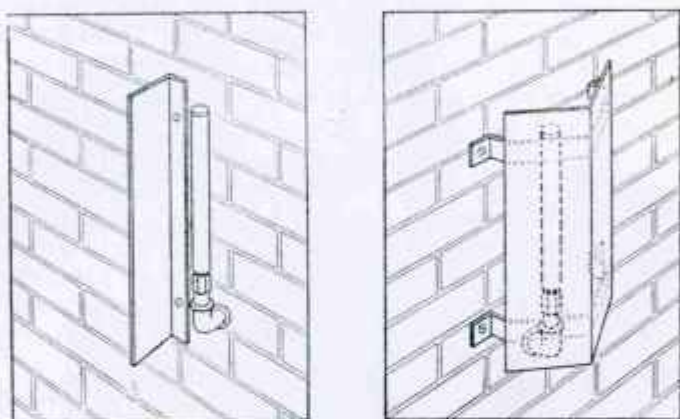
Emplacement du bulbe extérieur : A gauche, écran protecteur du bulbe extérieur situé sur la façade Est ou Ouest. A droite, écran protecteur du bulbe extérieur situé sur la façade Sud. (Nota : les bulbes de la façade Nord n'ont pas besoin d'écran protecteur) (Johnson Service Company).
